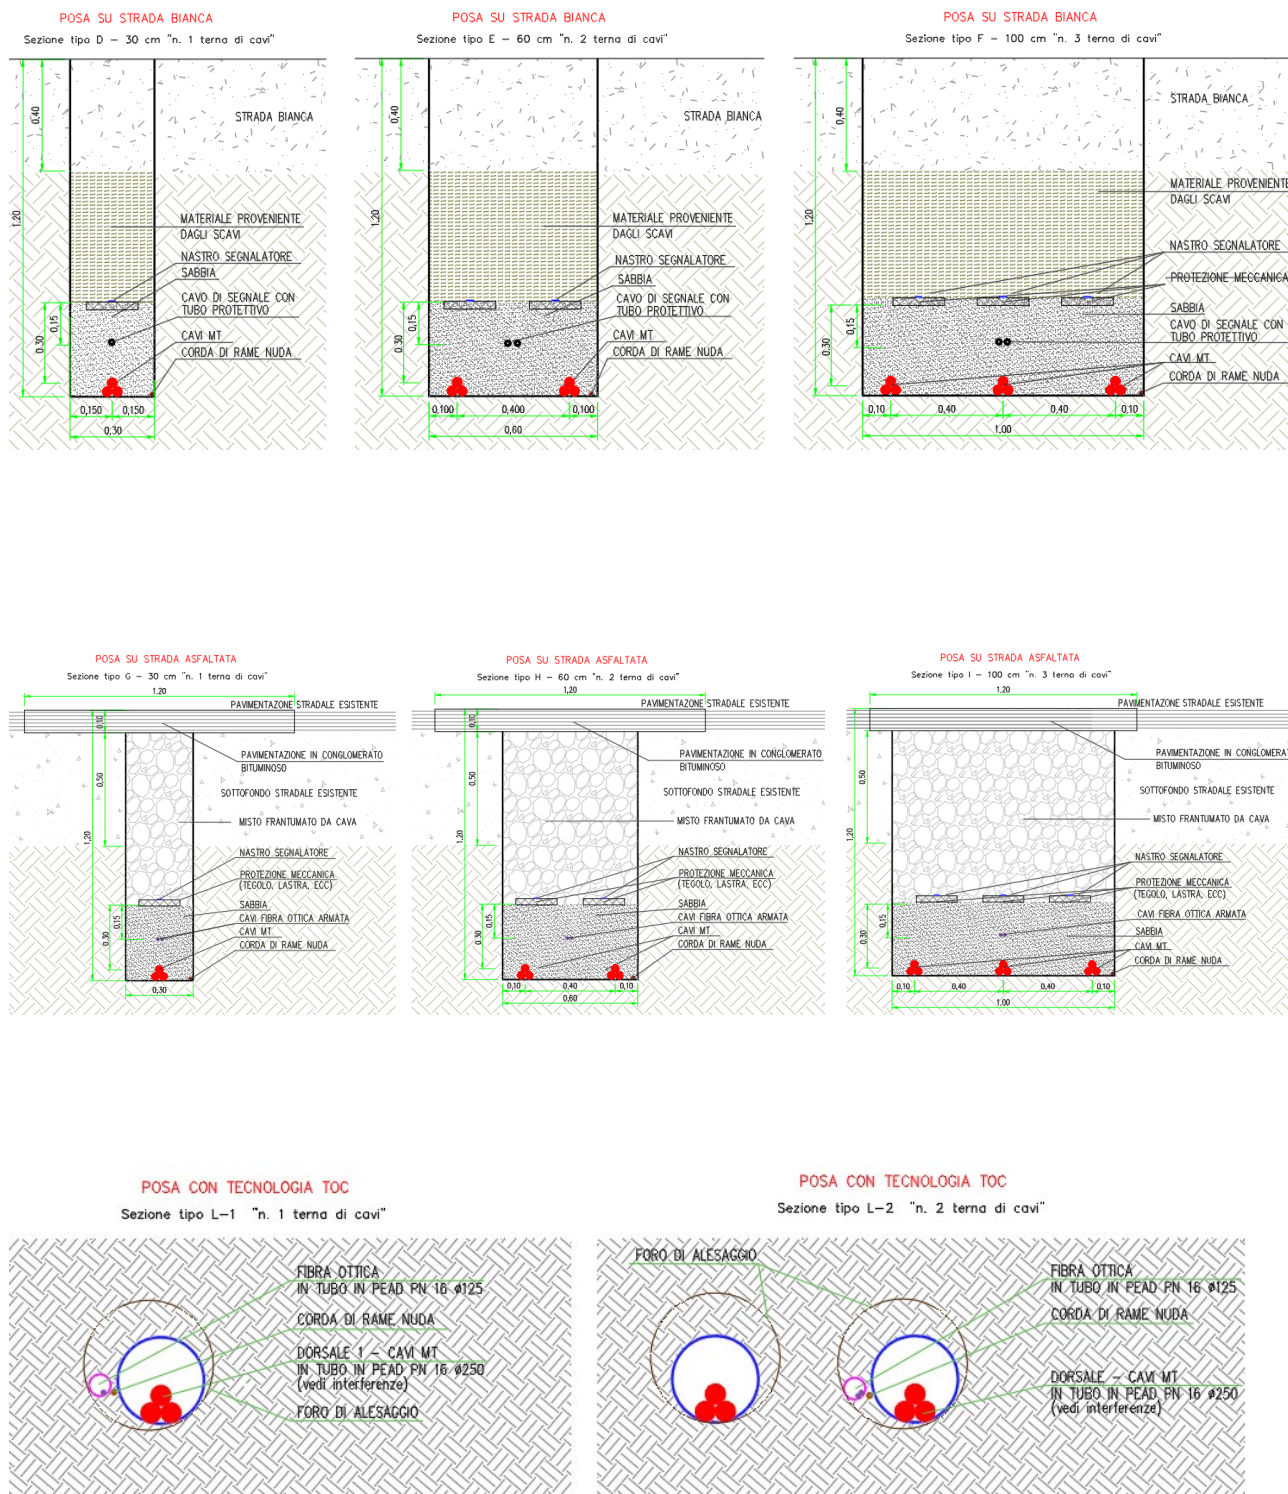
Sezioni tipiche di posa cavi MT
